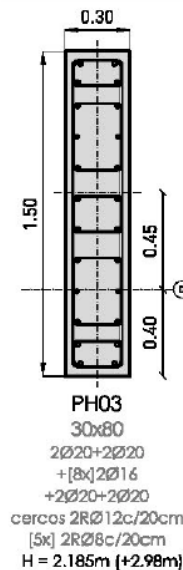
Pilar O2 Casa Balint. Fuente: David Gallardo.
